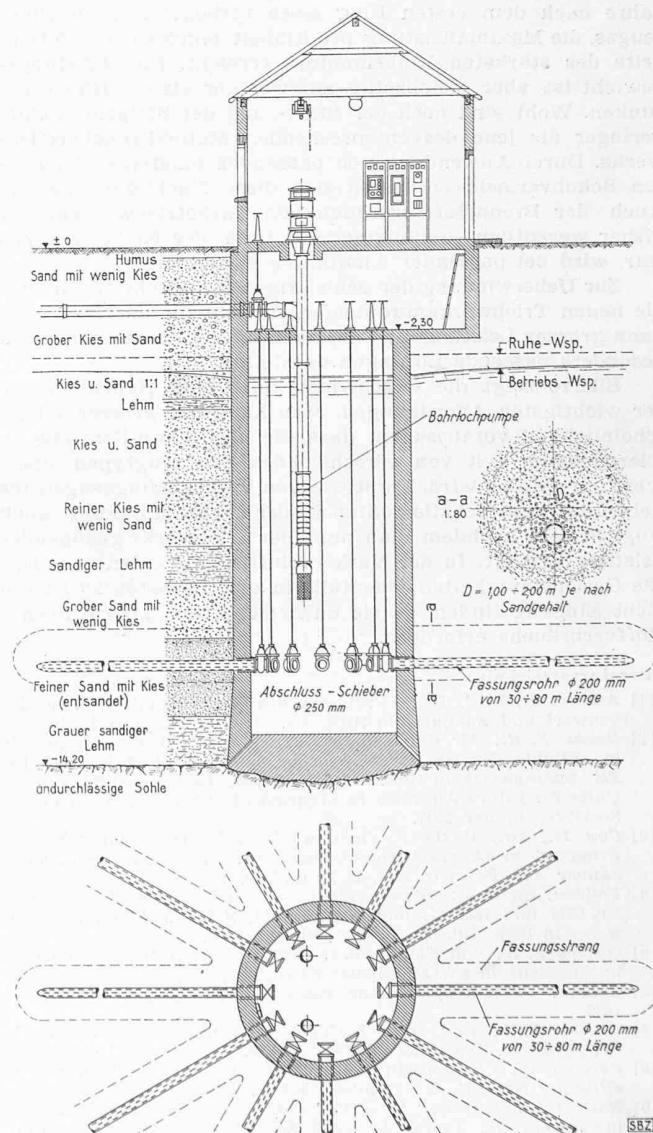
Sammelbrunnen mit horizontalen Fassungsrohren nach dem Ranney-Verfahren. — Masstab 1:200
